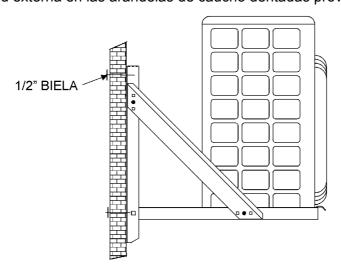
Instalación de la unidad externa en una estructura de estante metálica
